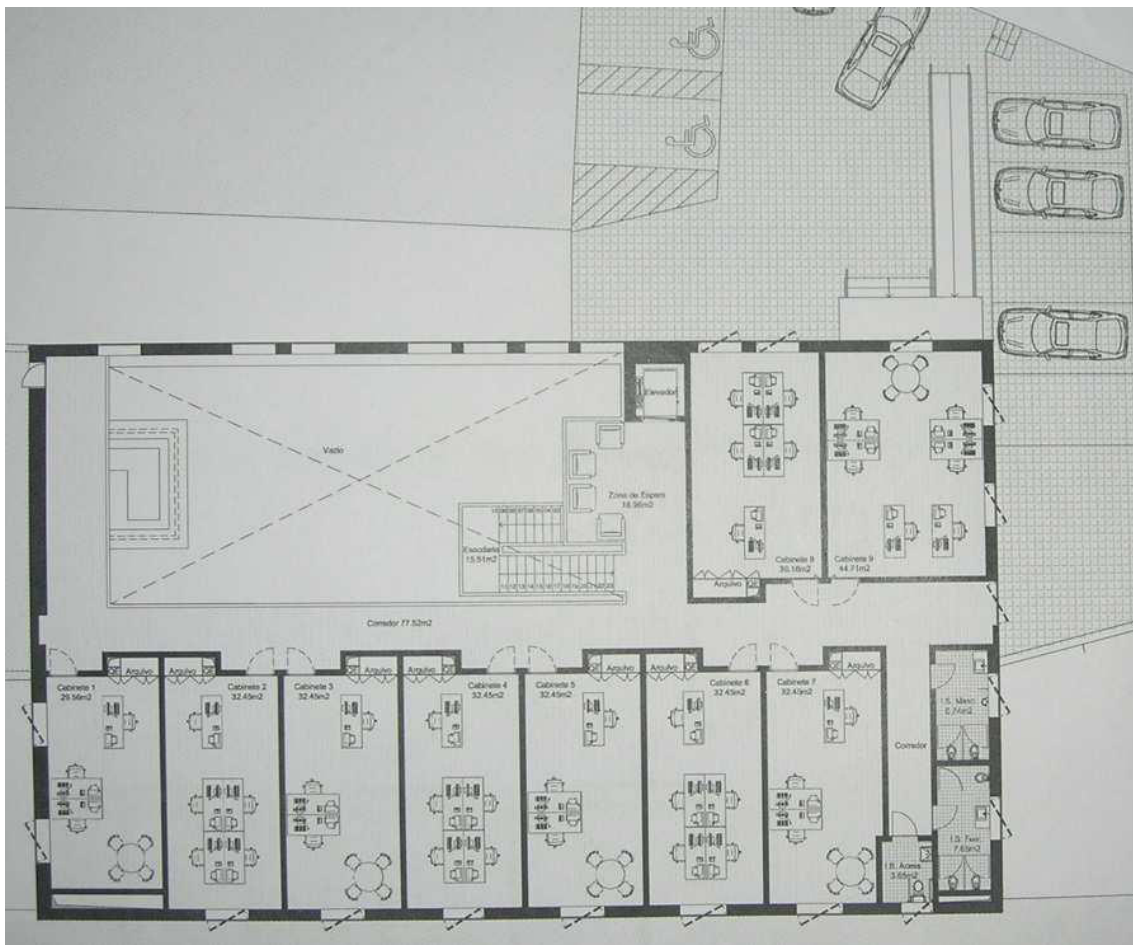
Planta da tela final para o 1º piso – “Ninho de empresas”
